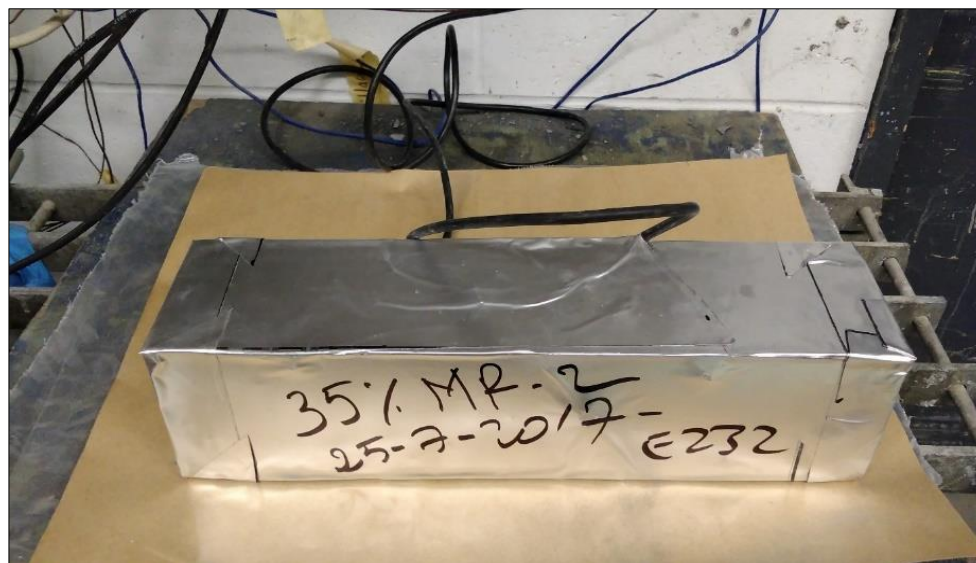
Poutre de béton emballée dans un film d'aluminium autocollant
